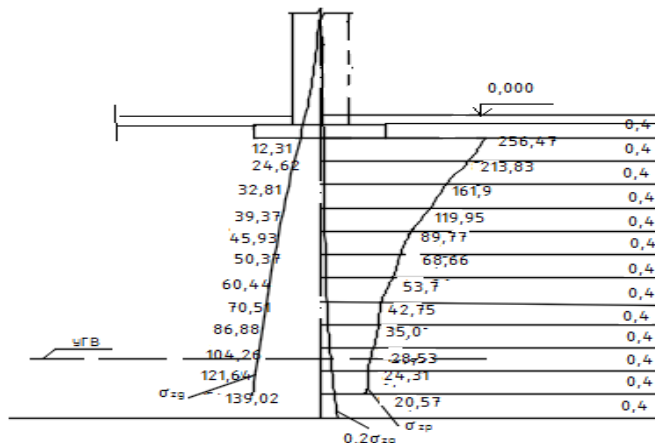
Эпюры напряжений под подошвой фундамента
